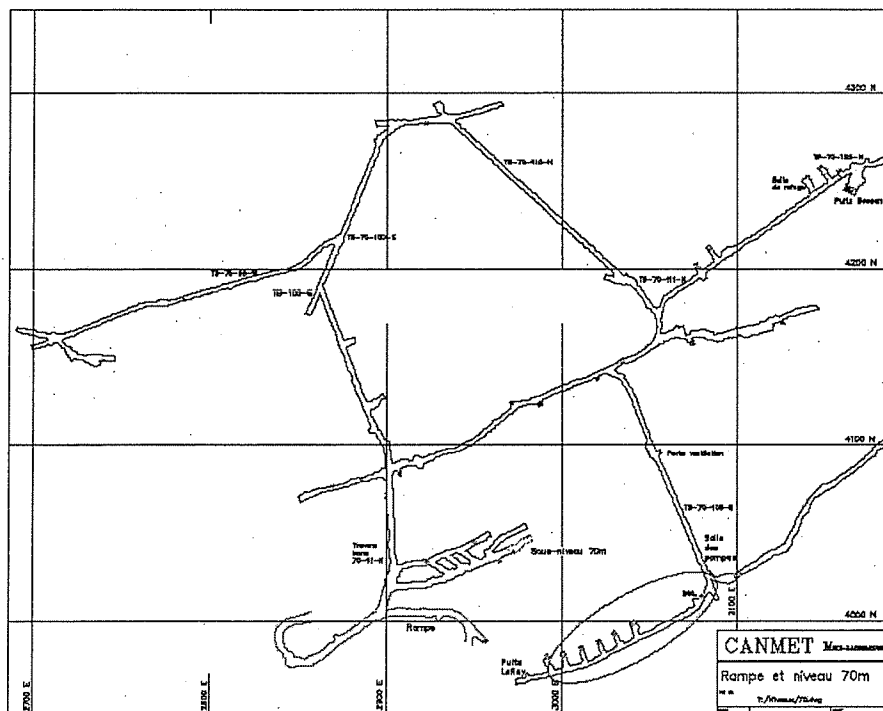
Plan du niveau 70 m et le site choisi pour la campagne de mesures.
